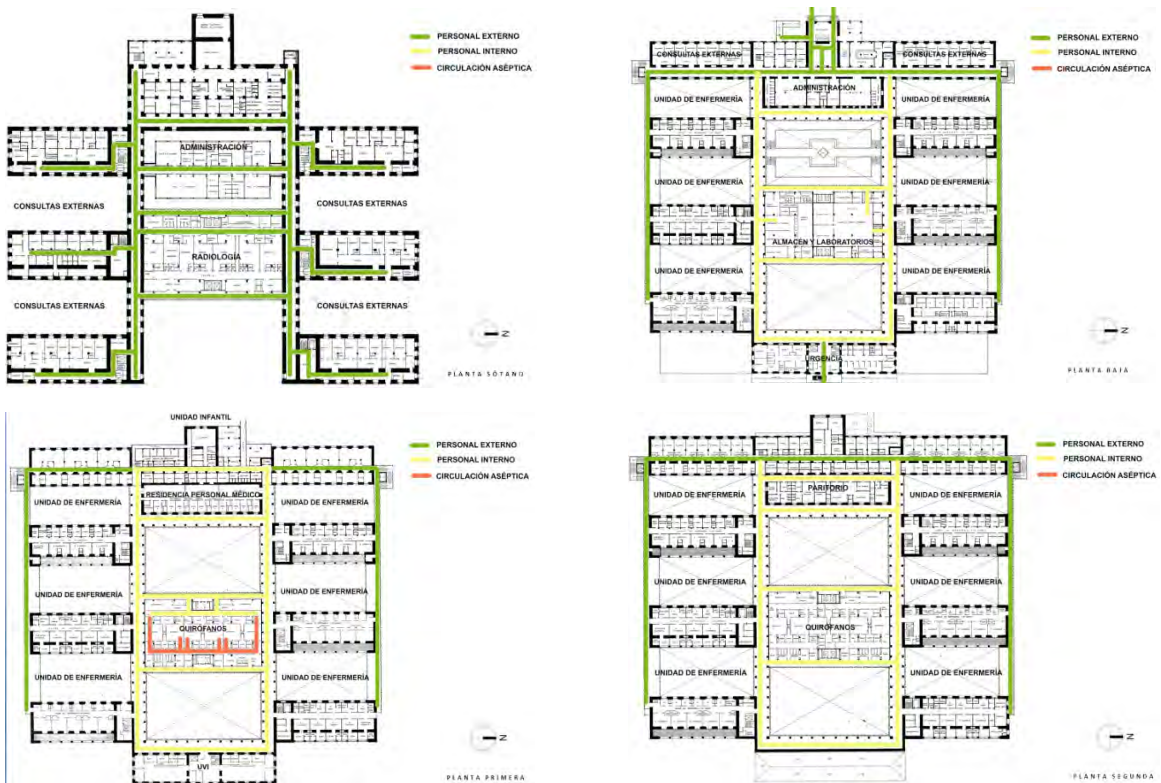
Hospital Civil. Planta sótano, planta baja, planta primera y planta segunda.
